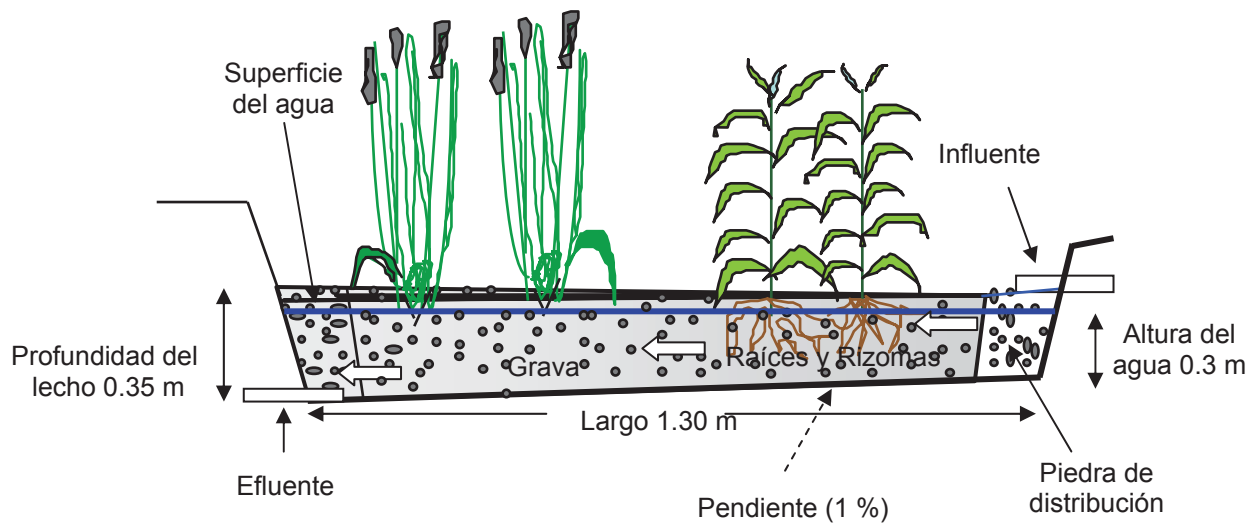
Vista lateral de las tinas usadas del humedal construido.
